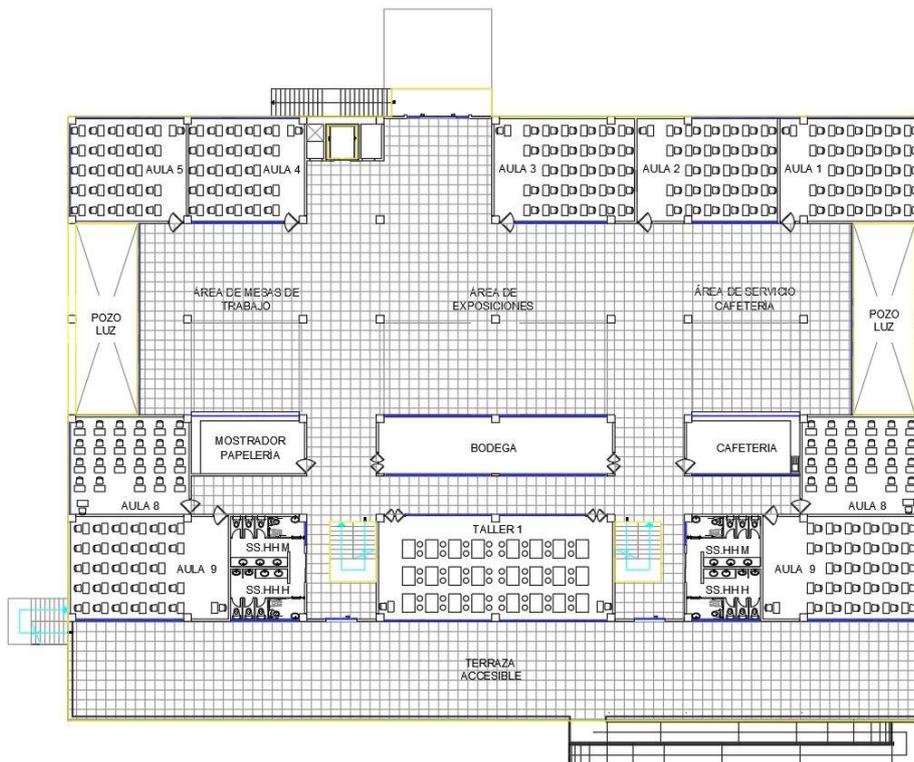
Planta de subsuelo arquitectónica nivel N+4.60 m
